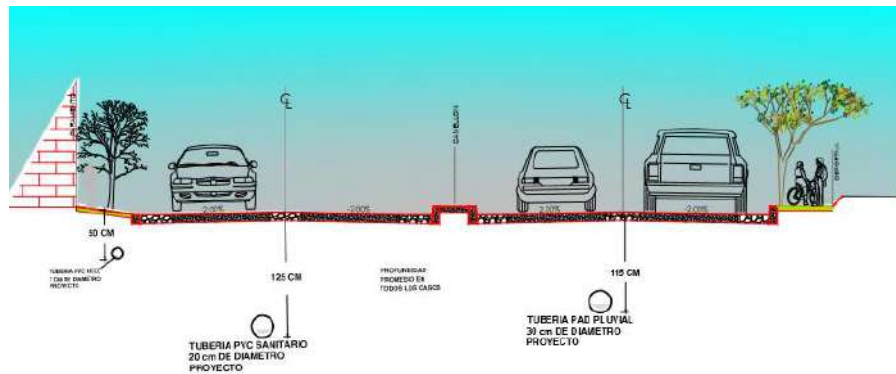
Corte de calle, drenaje sanitario. Plano de drenaje sanitario de la calle.
